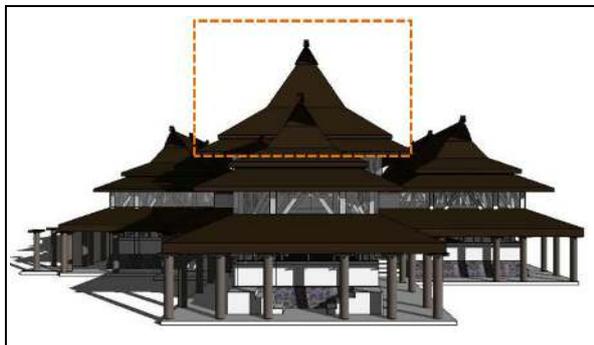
Simetri Pada Tampak Bangunan Aula Barat ITB
